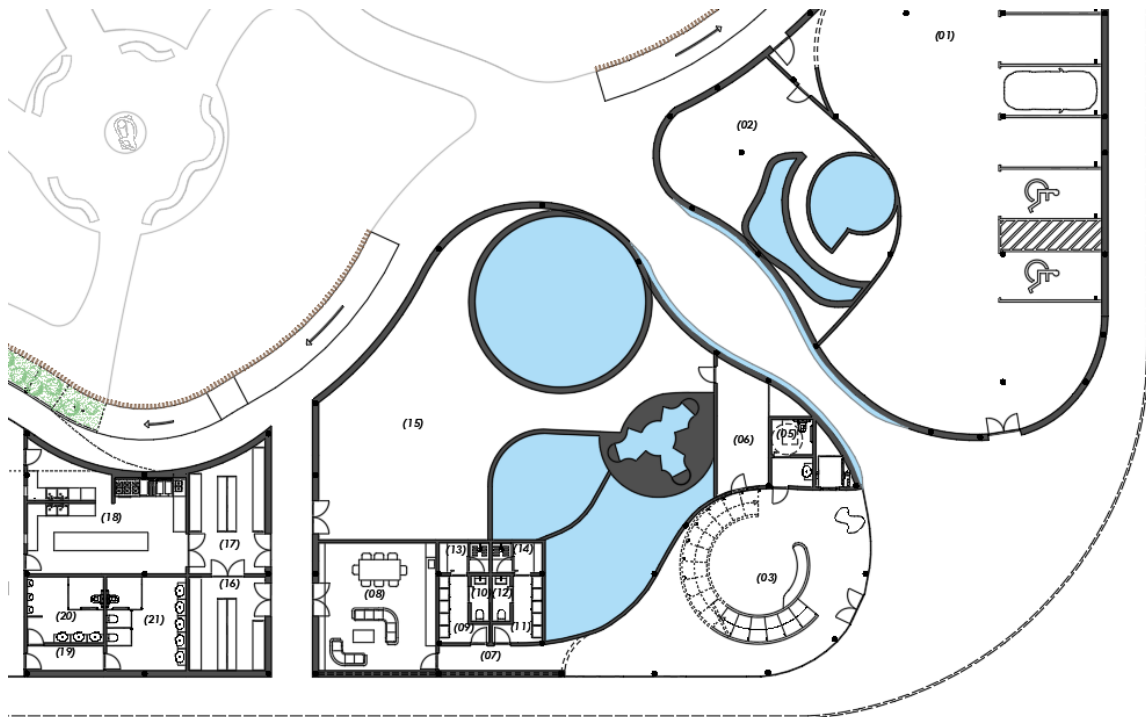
PLANTA DO PISO 0 DA UNIDADE DE TALLASSOTERAPIA
